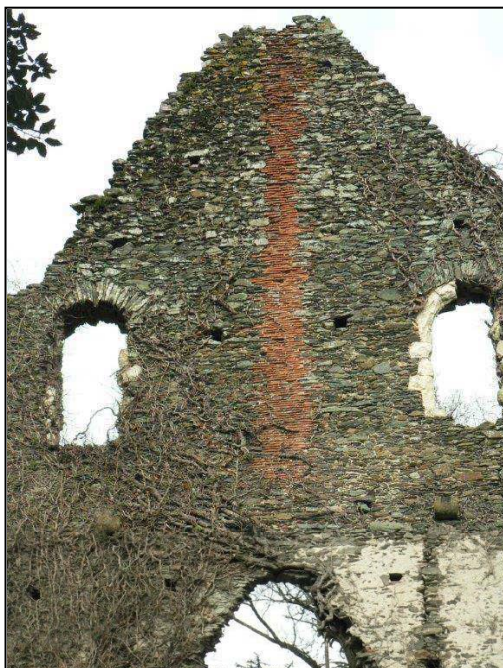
Vieille-cour à Oudon : conduit de cheminée
